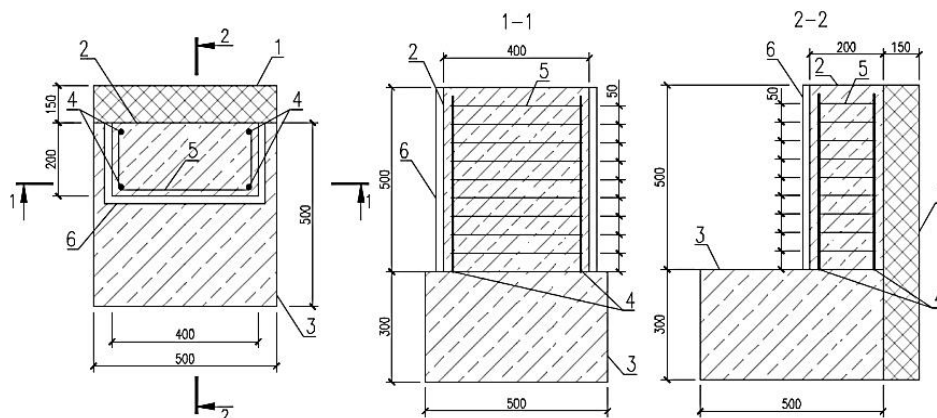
Схема фрагмента колонны и основания: 1 – утеплитель, 2 – колонна, 3 – основание, 4 – арматурные стержни, 5 – греющий провод, 6 – опалубка
